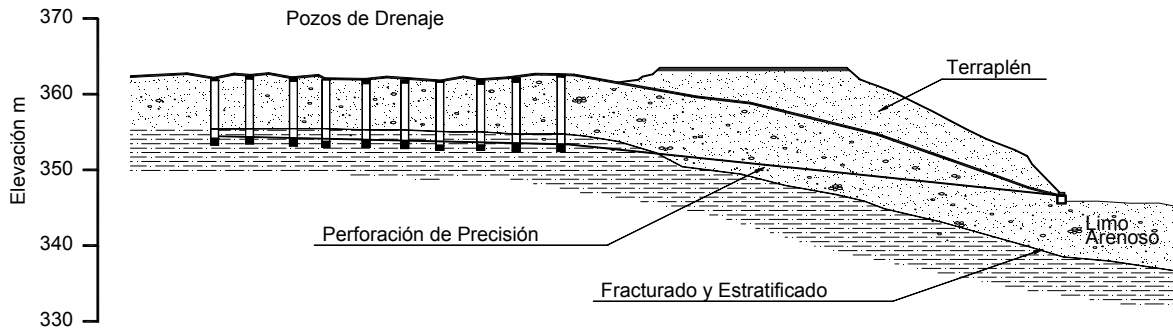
Pozos verticales conectados con ductos horizontales de PVC para desagüe (Colotta, 1988).
